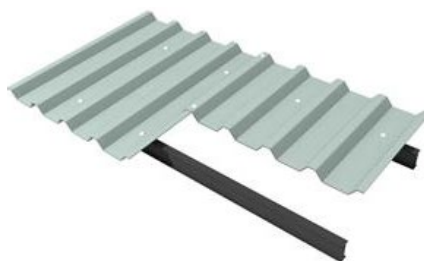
Einschalige Dachdeckung mit Trapezprofilblechen
